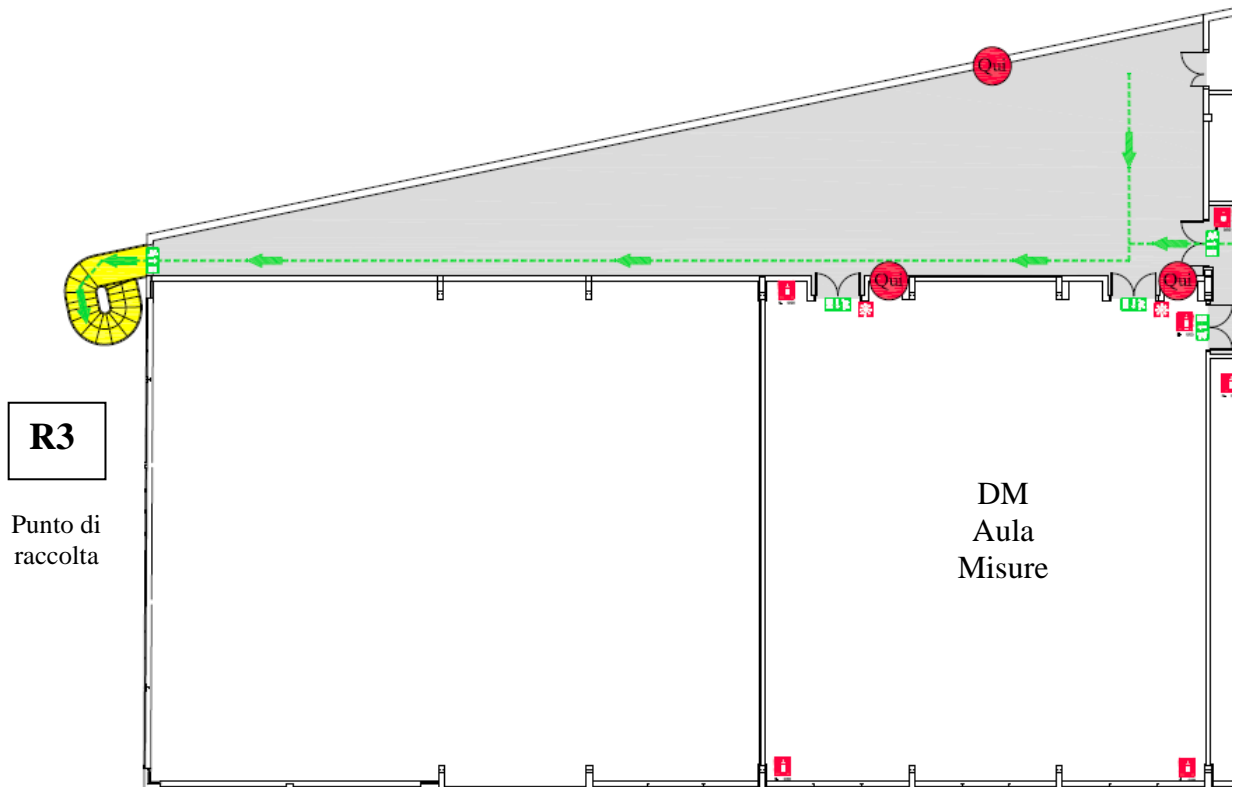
Pianta dell'edificio B13 - Piano Primo (Parte II)
